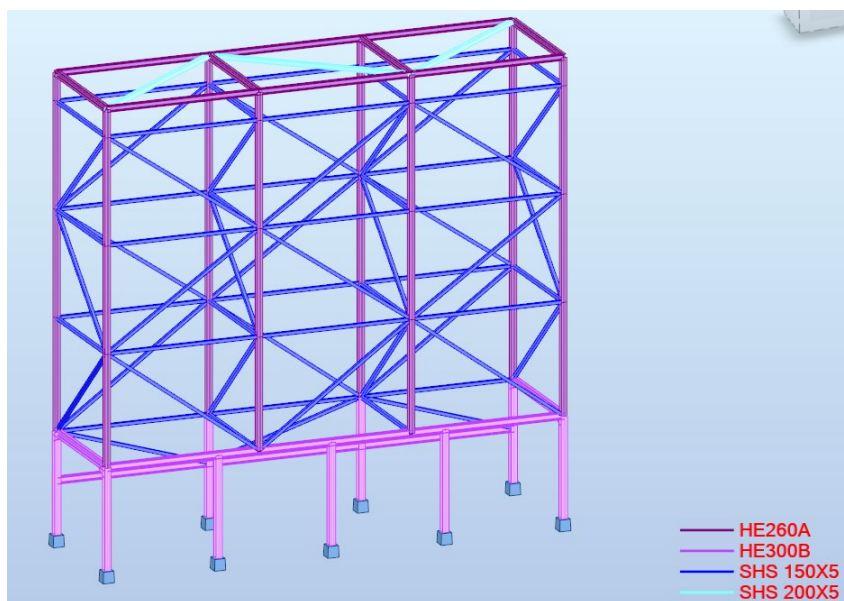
Vista Global da estrutura com as secções transversais dos elementos estruturais
